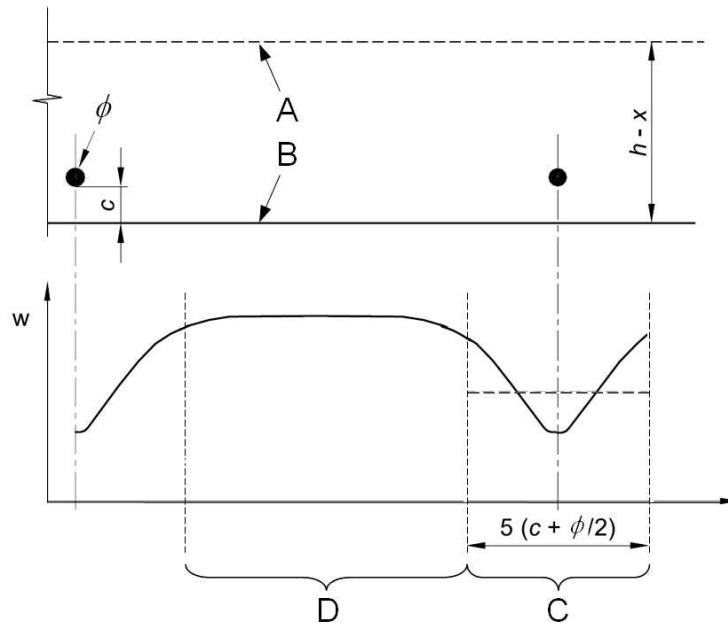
Ampiezza delle fessure, w , in funzione della posizione rispetto alle barre di armatura.
